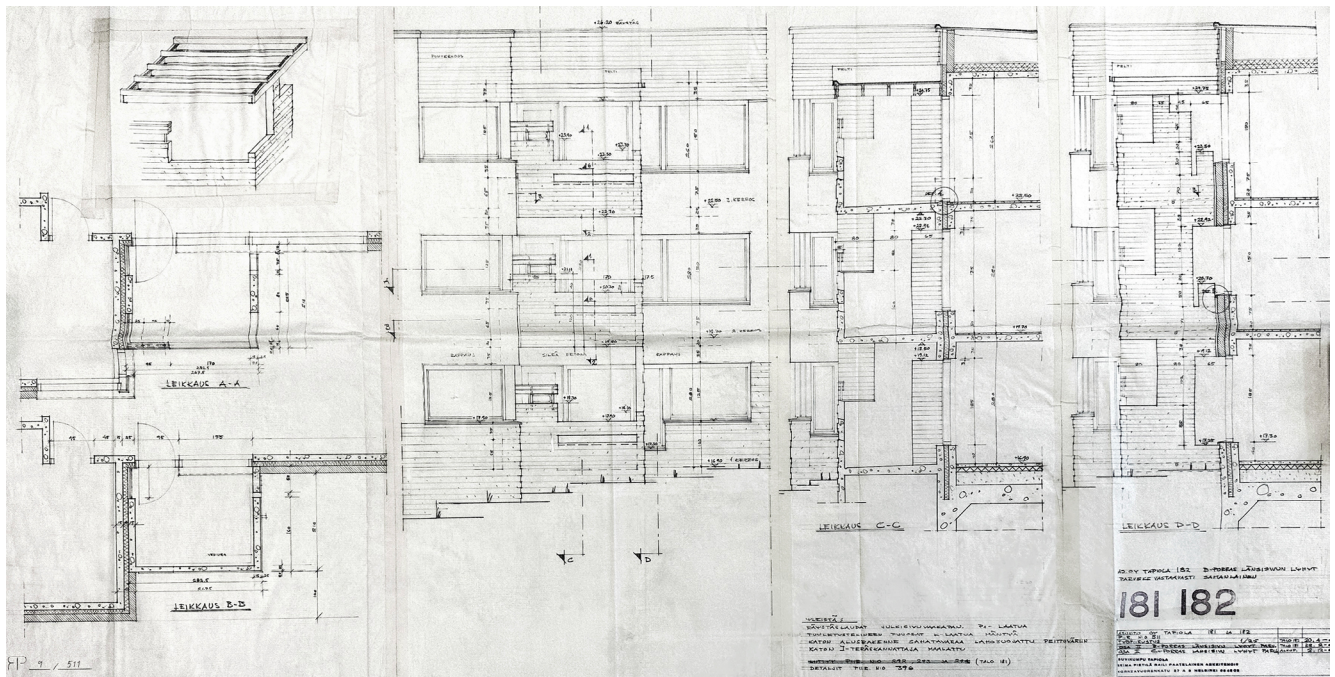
Plano 9/511. Secciones y alzados de las habitaciones exteriores del lado oeste, bloques 181 y 182. Ref, 9/511. [Fuente: MFA]
